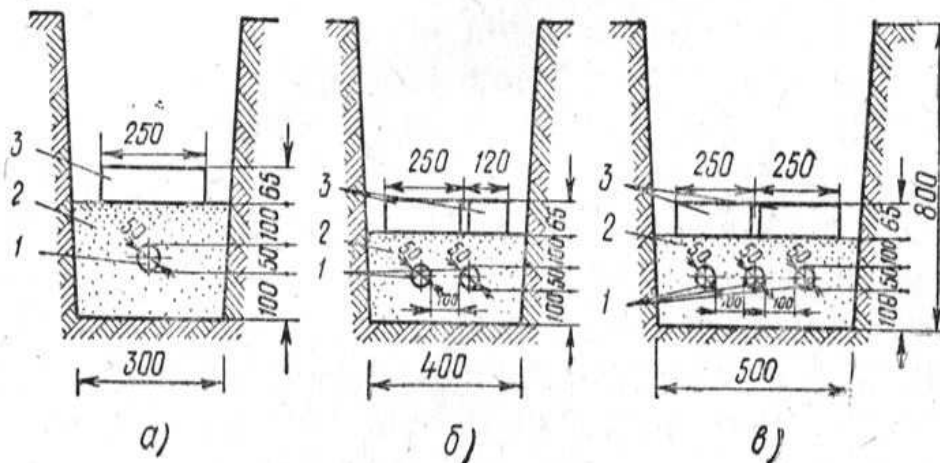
Прокладка кабелей в траншеях с покрытием кирпичом
